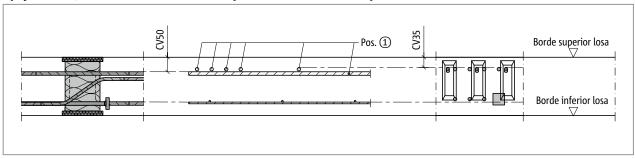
Schöck Isokorb® XT tipo C: Armadura in situ esquinero externo (sección XT tipo C-L-CV50, vista XT tipo C-R-CV35)
